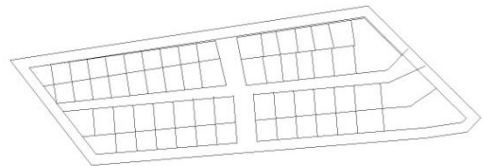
Site Plan Griya Pondok Indah Sumber : Siteplan Griya Pondok Indah dan Survey Lapangan, 2014
